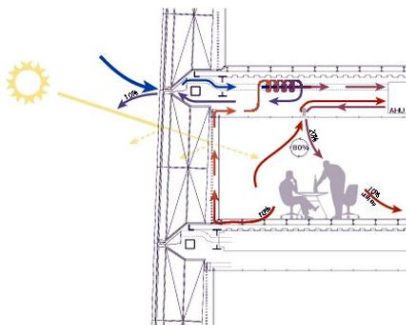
مسقط أفقي يوضح الانشاء
